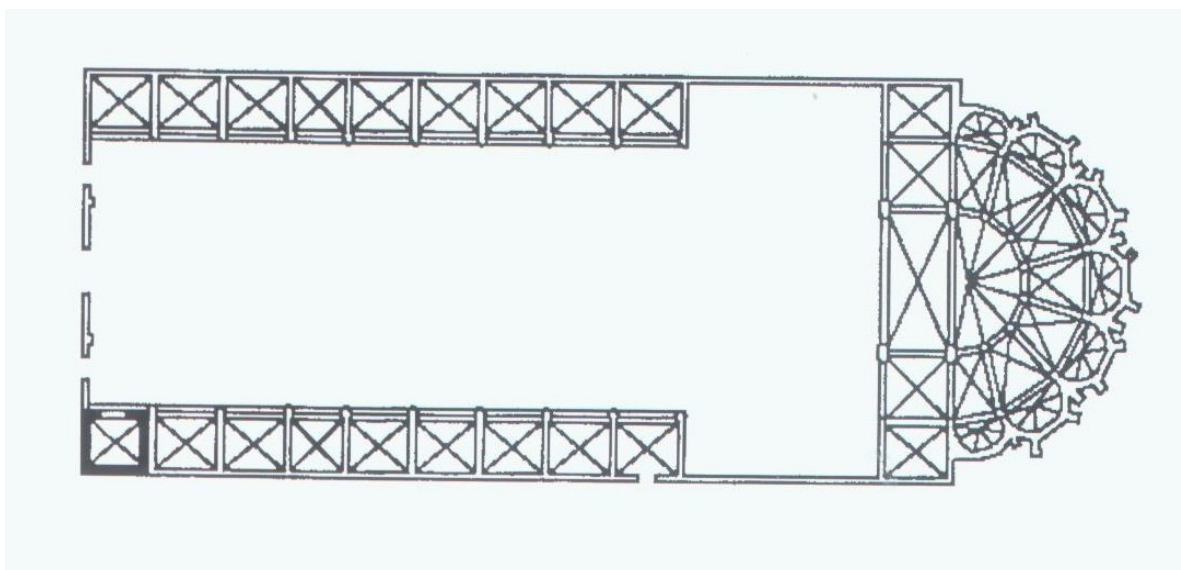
Neapel, S. Lorenzo Maggiore, Grundriss, fr. 14. Jh.
